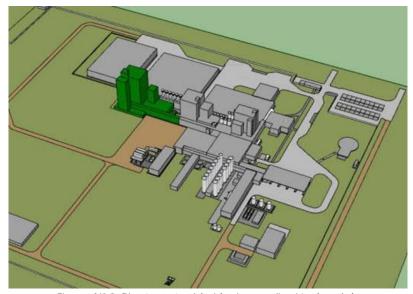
Planta actual (gris) y la ampliación (verde).
